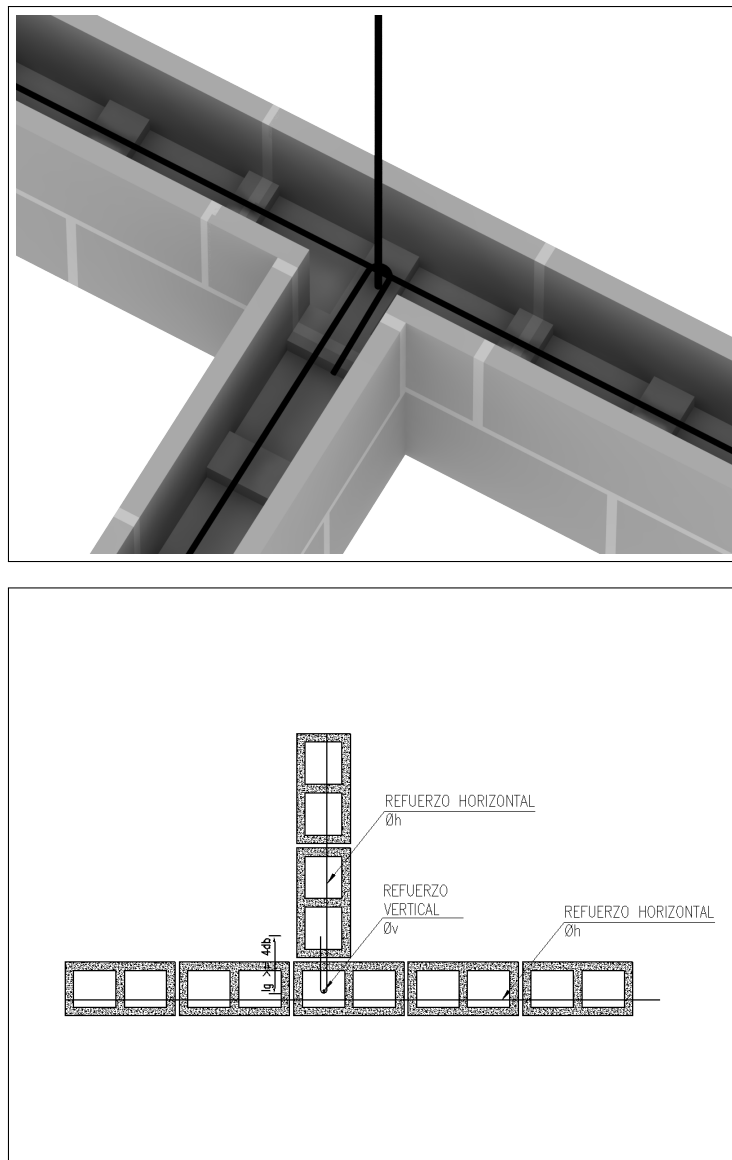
Detalle de las barras de refuerzo horizontal en el encuentro de muros en T.
